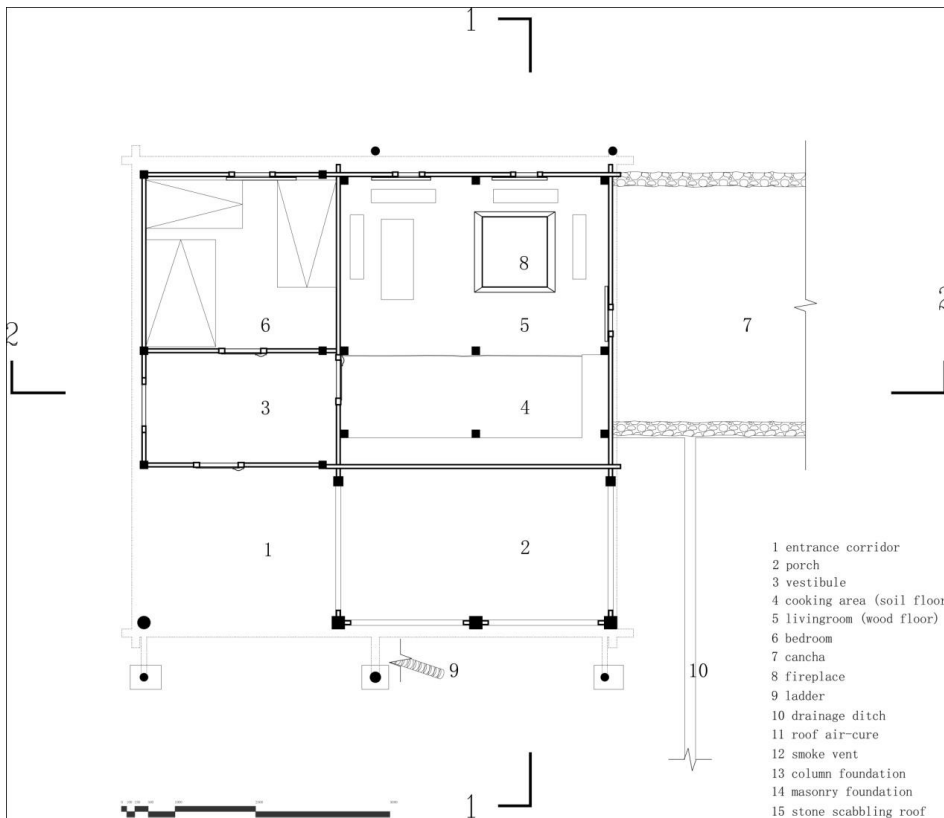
秋那桶村嘎干堂组何宅正屋平面图
